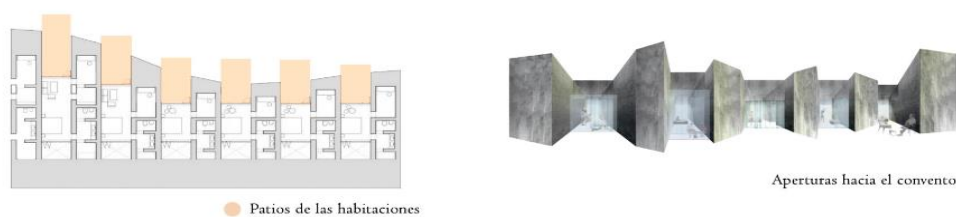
Reinterpretación de la muralla. Elaboración adaptada de Archdaily
